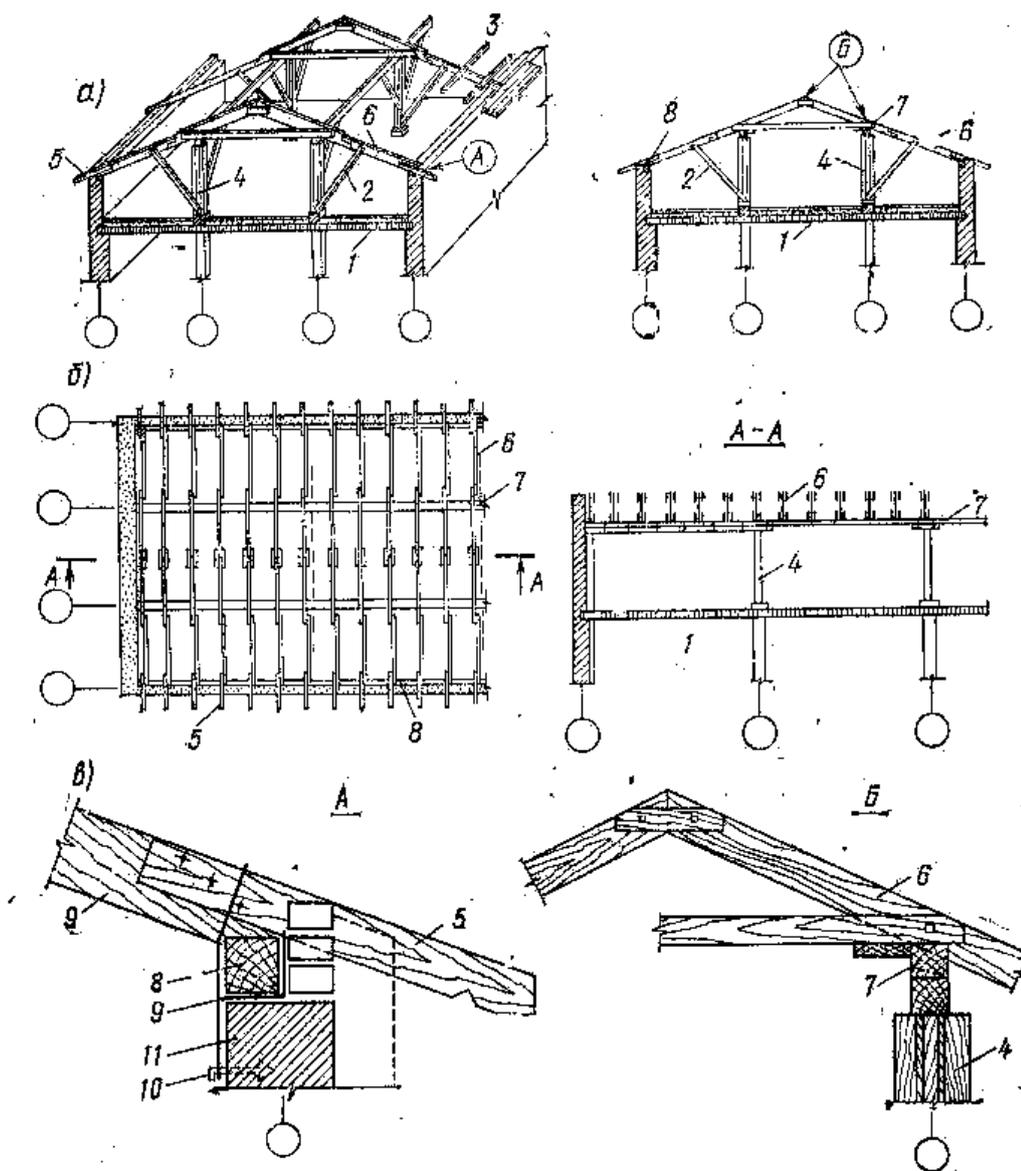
Конструктивные элементы двускатных чердачных деревянных крыш: а-общий вид чердачной крыши; б-расположение стропил в здании; в-детали узлов двускатных деревянных крыш; 1-чердачное перекрытие; 2-подкос; 3-обрешетка; 4-пилястра; 5-кобылка; 6-стропильная нога; 7-прогон; 8-мауэрлат; 9-толь; 10-костыль; 11-проволочная скрутка.
